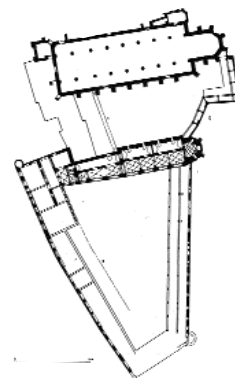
Halle, Residenz, Grundriß mit Rekonstruktion des Verbindungsganges zum Dom
